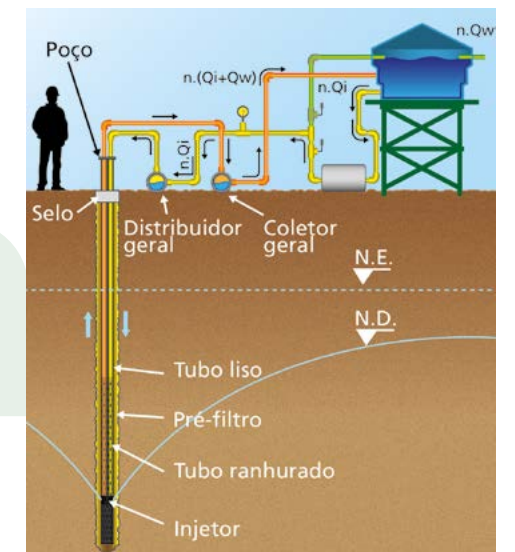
Montagem geral do rebaixamento por poços injetores.
